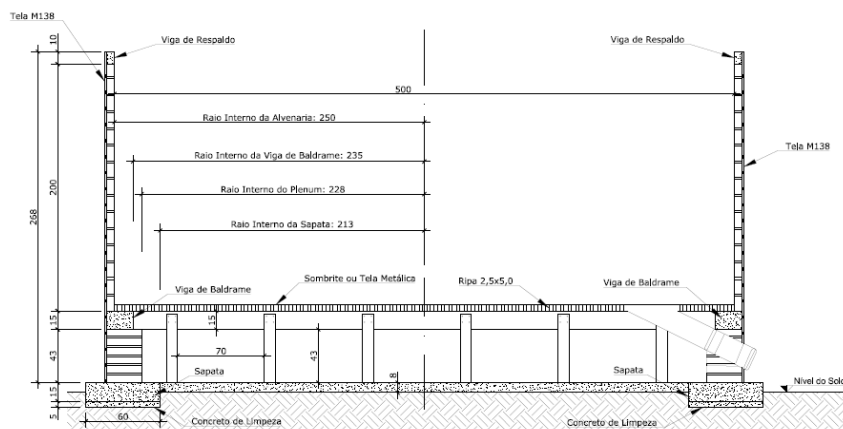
Corte transversal com o detalhamento das dimensões do silo
